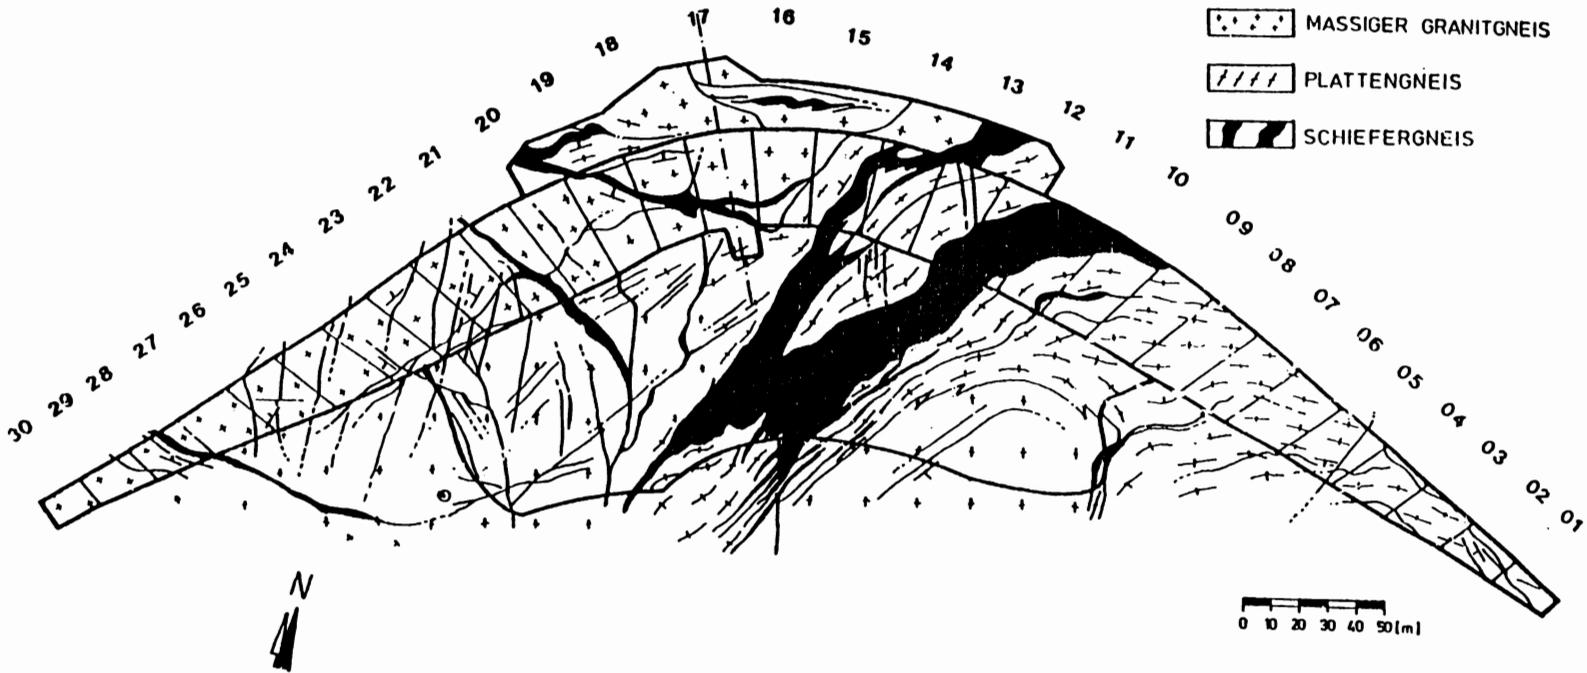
Geologie an der Sperrenstelle, Lageplan
